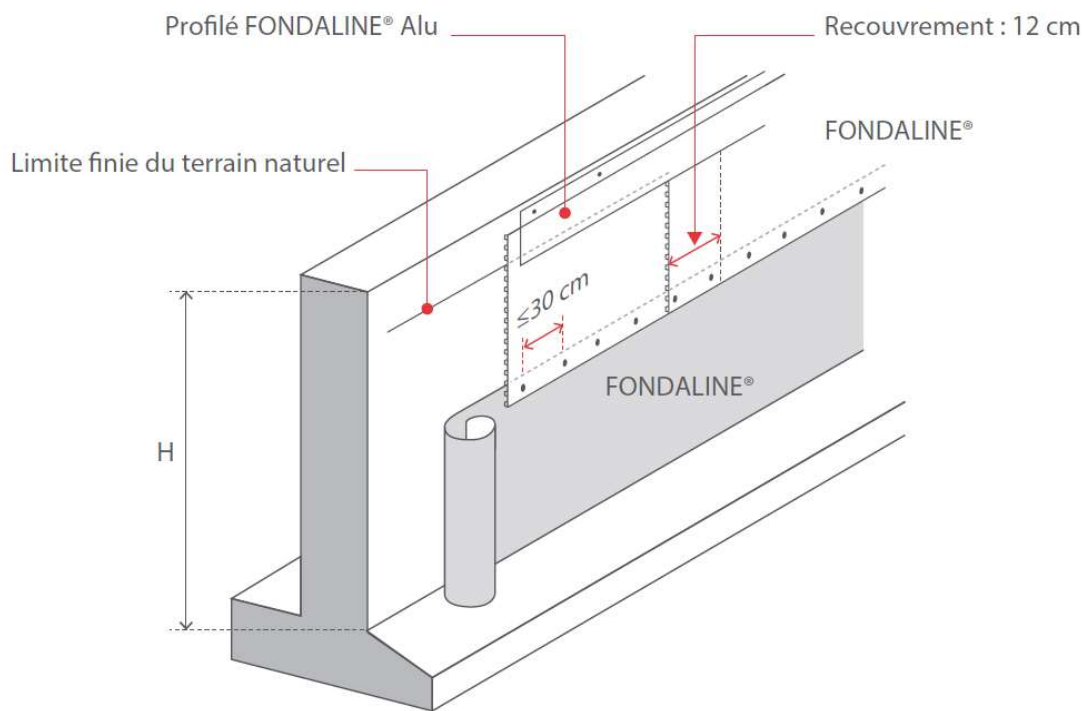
Fixation haute des nappes FONDALINE 4SB et FONDALINE 5SB sur support en maçonnerie
